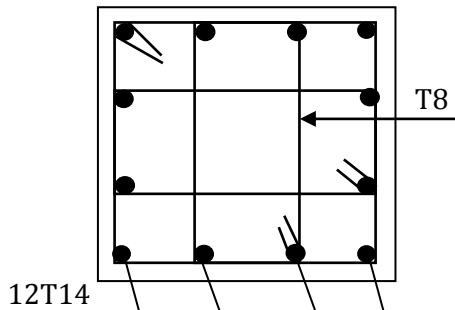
Schéma de ferrailage des poteaux 8, 9, 10 et 11<sup>ème</sup> étage
